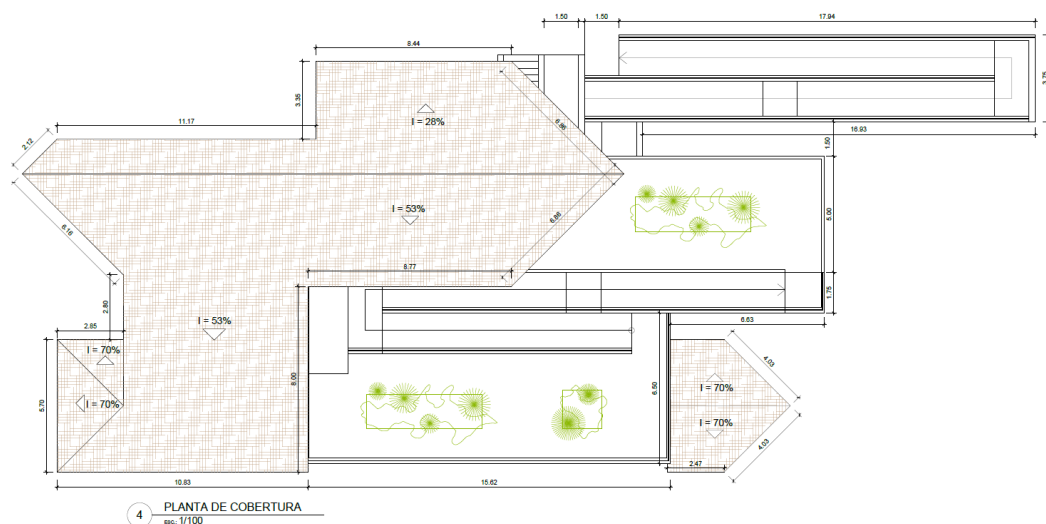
Planta de cobertura, mesclando estruturas de madeira cobertas por fibras de piaçava e terraços-jardim.
